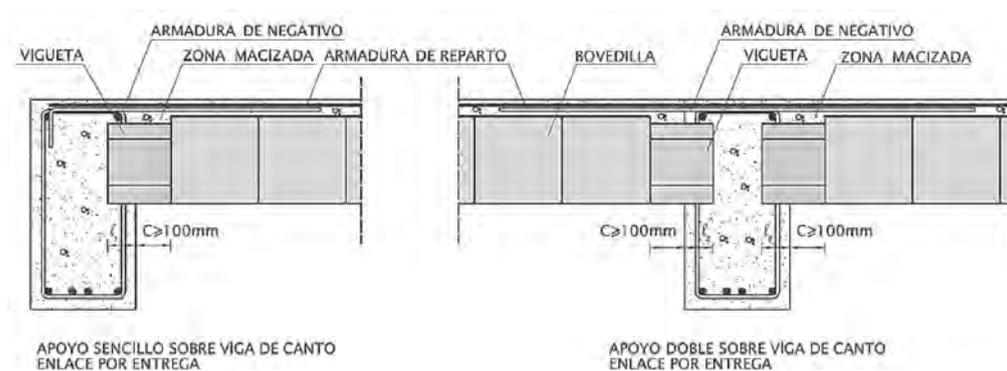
apoyo sobre viga de canto. Enlace por entrega.
